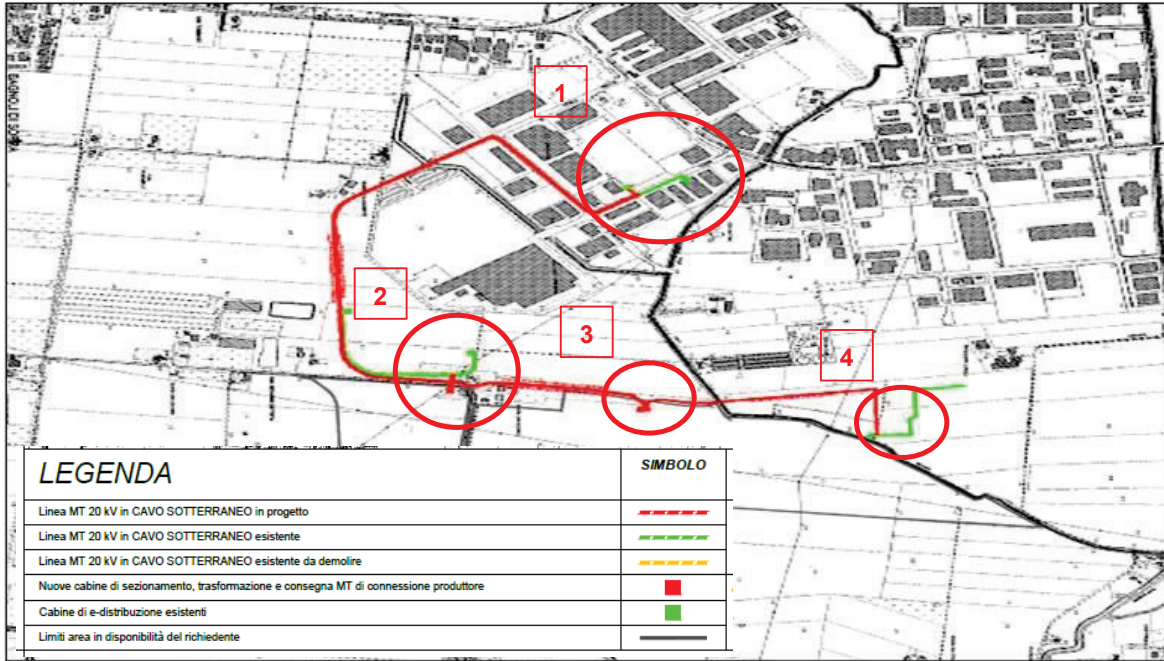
Posizione linea elettrica di collegamento e individuazione tratti
